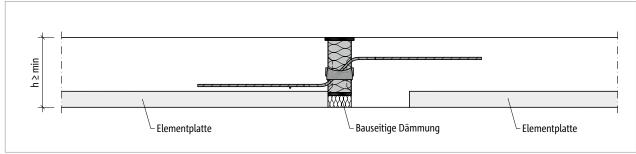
Schöck Isokorb® T Typ QL: Elementdecke mit aufgesetzten Schöck Isokorb®
